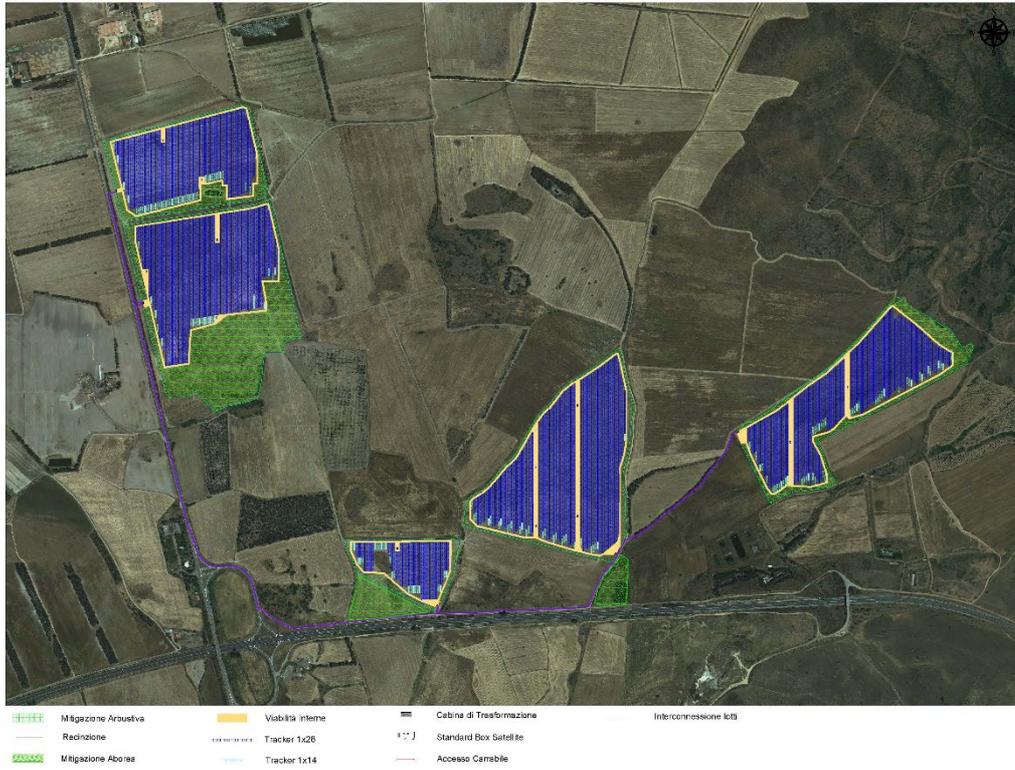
Ortofoto dell'area d'impianto ricadente sul territorio di Siliqua (SU)
